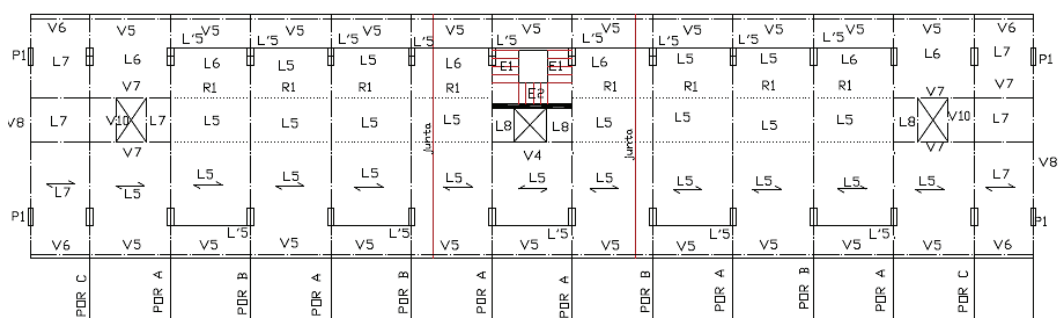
Planta estrutural do piso inferior tipo (1º, 3º, 5º e 7º) [26].
